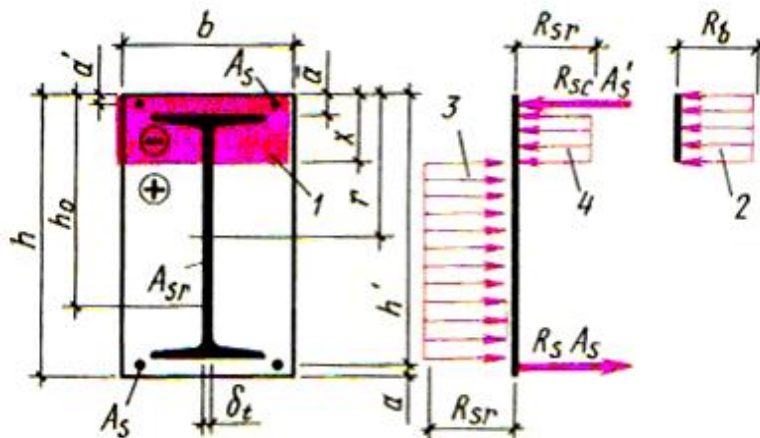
Армуння елемента жорсткою арматурою високим профілем: 1 – стиснута зона перерізу, 2 – напруження в бетоні стиснутої зони, 3 – напруження розтягу в жорсткій арматурі, 4 – напруження стиску в жорсткій арматурі
